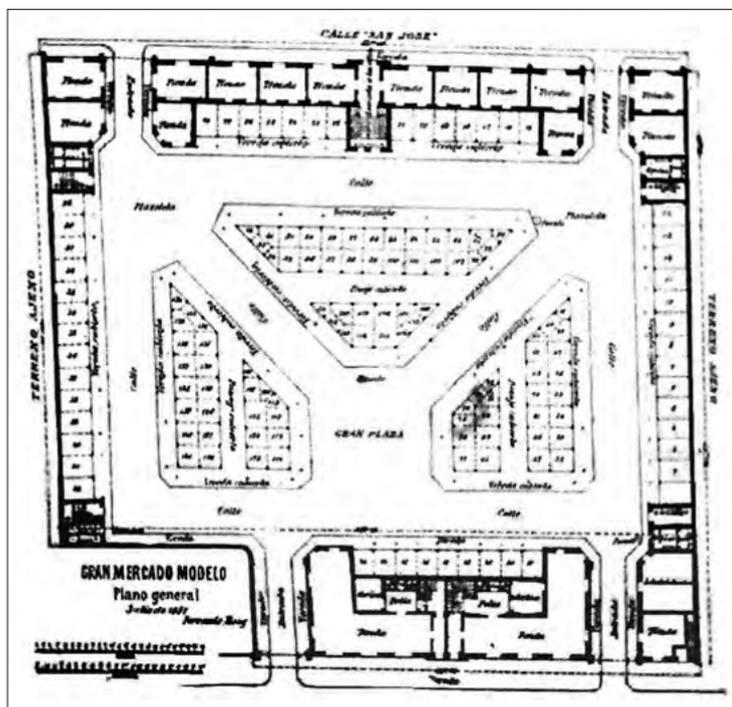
Planta del Mercado Modelo de Buenos Aires.
